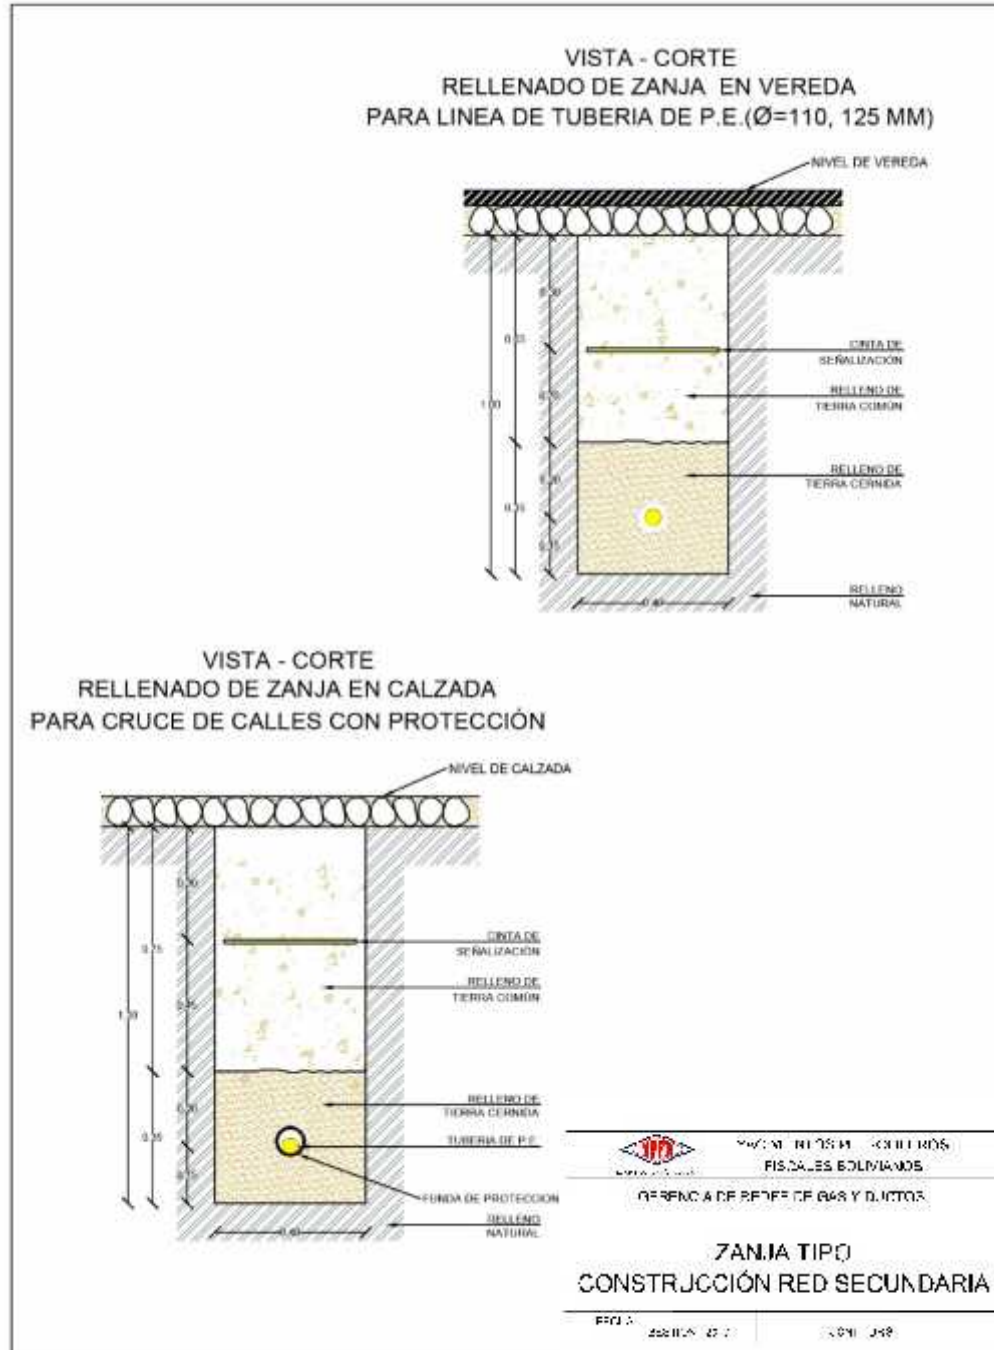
ZANJA TIPO CONSTRUCCIÓN RED SECUNDARIA
